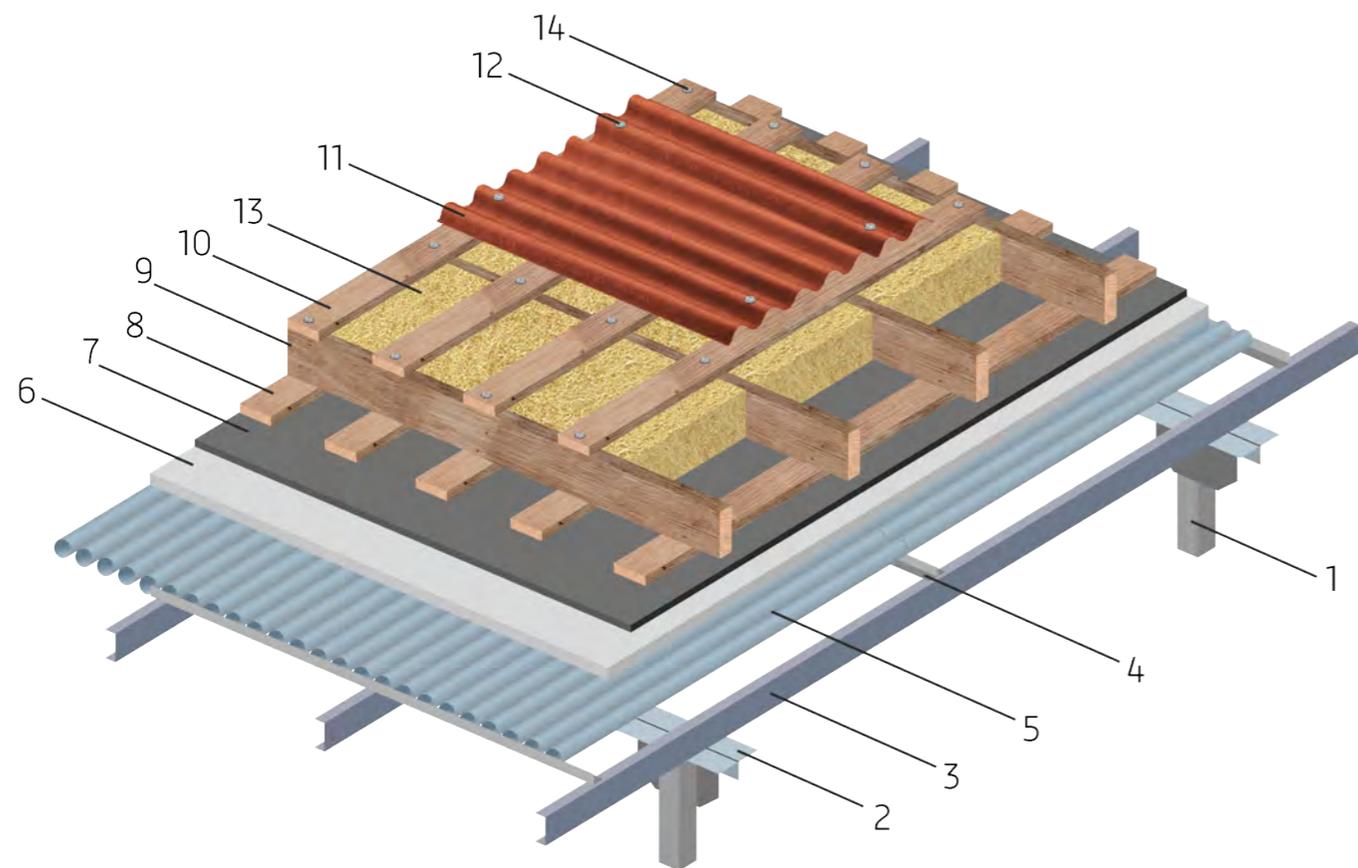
Составное перекрытие зданий и сооружений с применением труб
